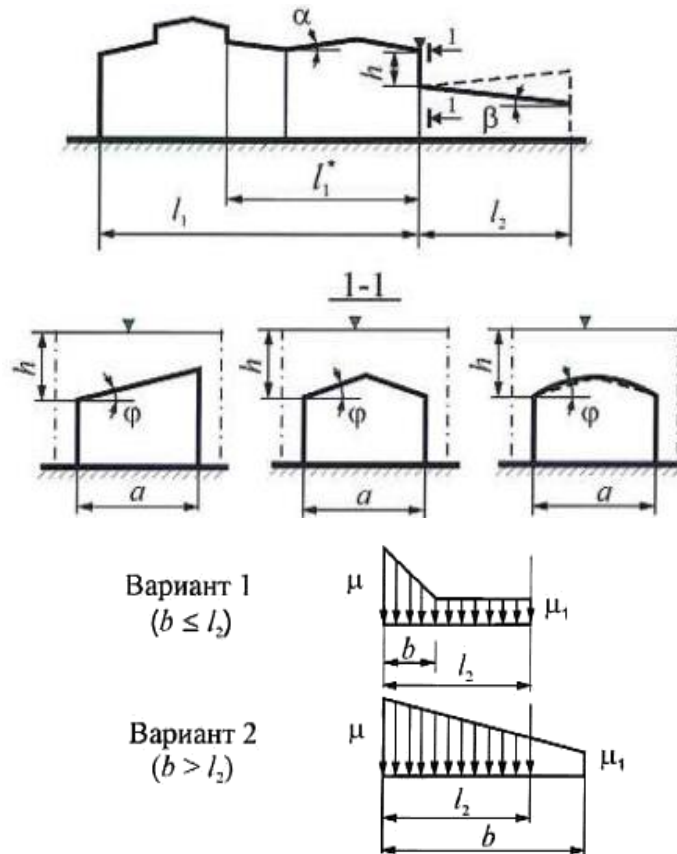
Расчетная схема перепадов высоты здания
